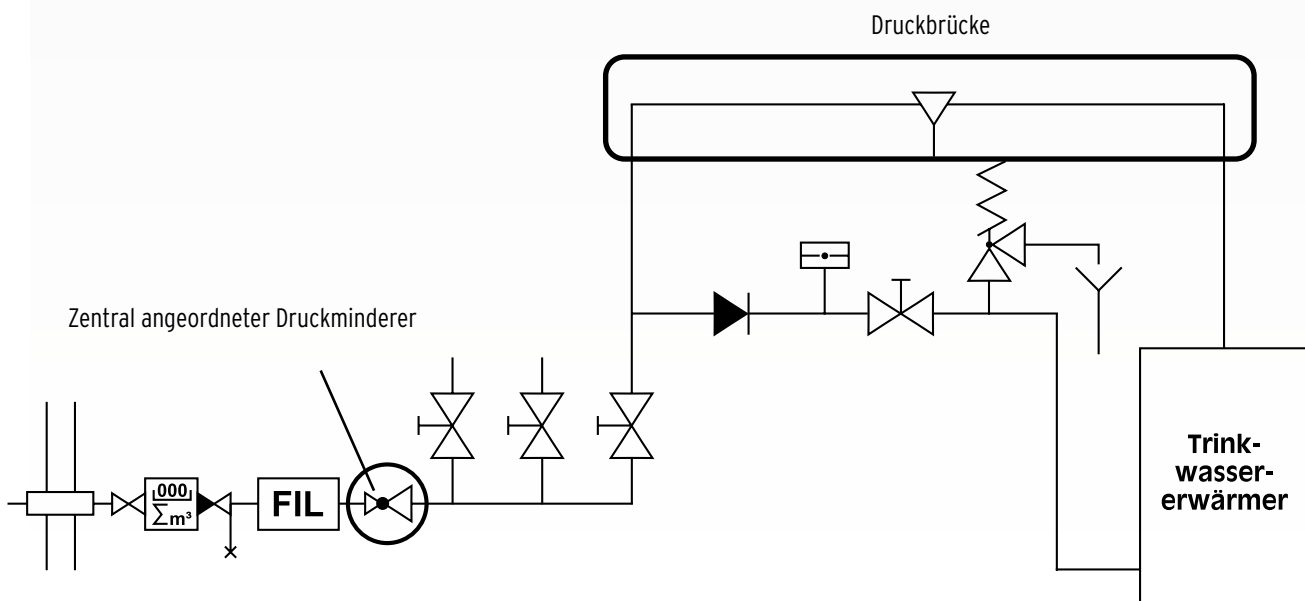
Druckbrücke vom Warmwasser zum Kaltwasser beim Aufheizen des Trinkwassererwärmers
